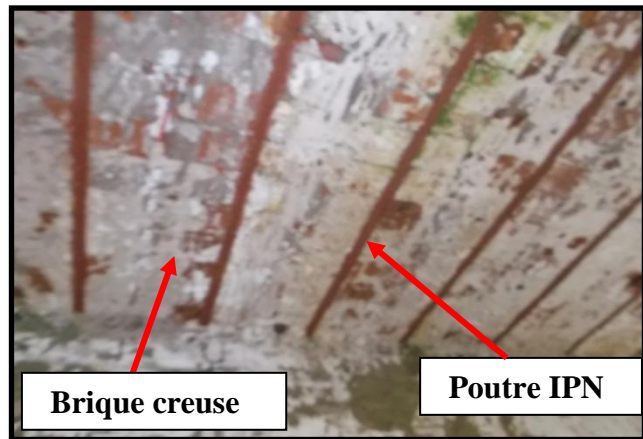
36: Vue sur le plancher du bâtiment principal.
